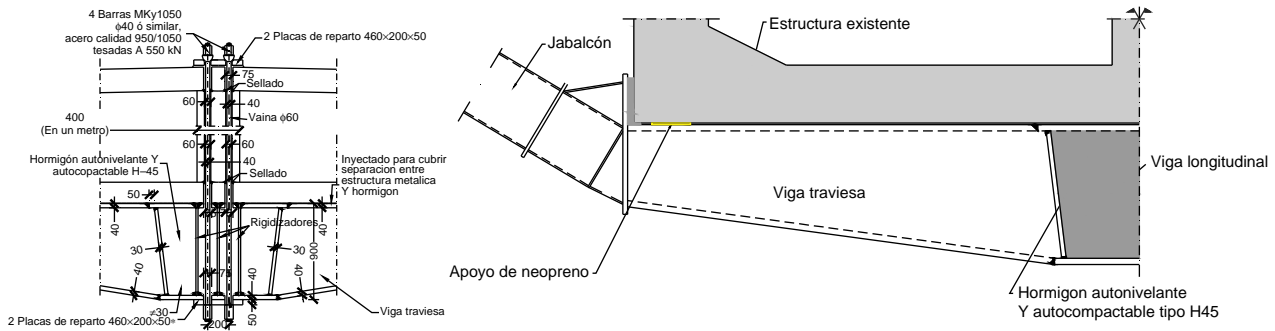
Barras verticales de cuelgue. Anclajes superior e inferior mediante placas de reparo (izquierda) y viga transversal con apoyo de neopreno entre estructura existente y estructura metálica (derecha).
